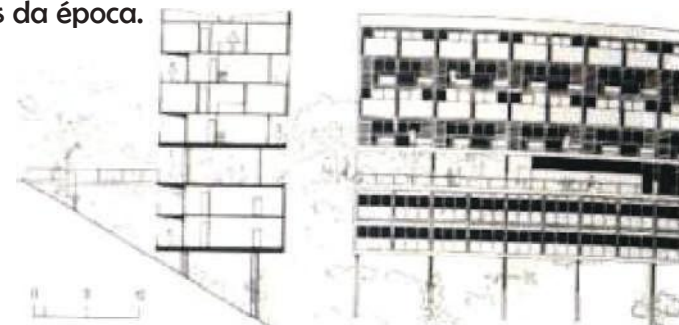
Implantação e vista fachada com o acompanhamento do terreno
